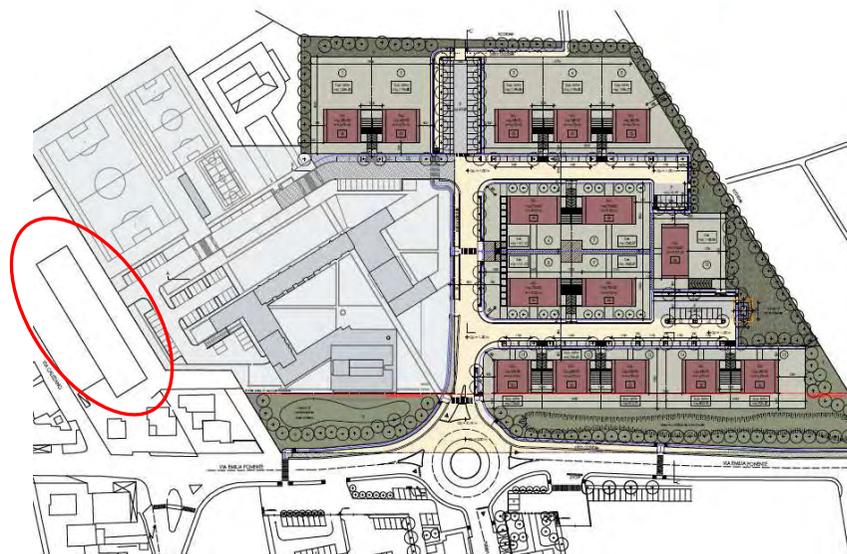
Planimetria di progetto 05/04 AT3
